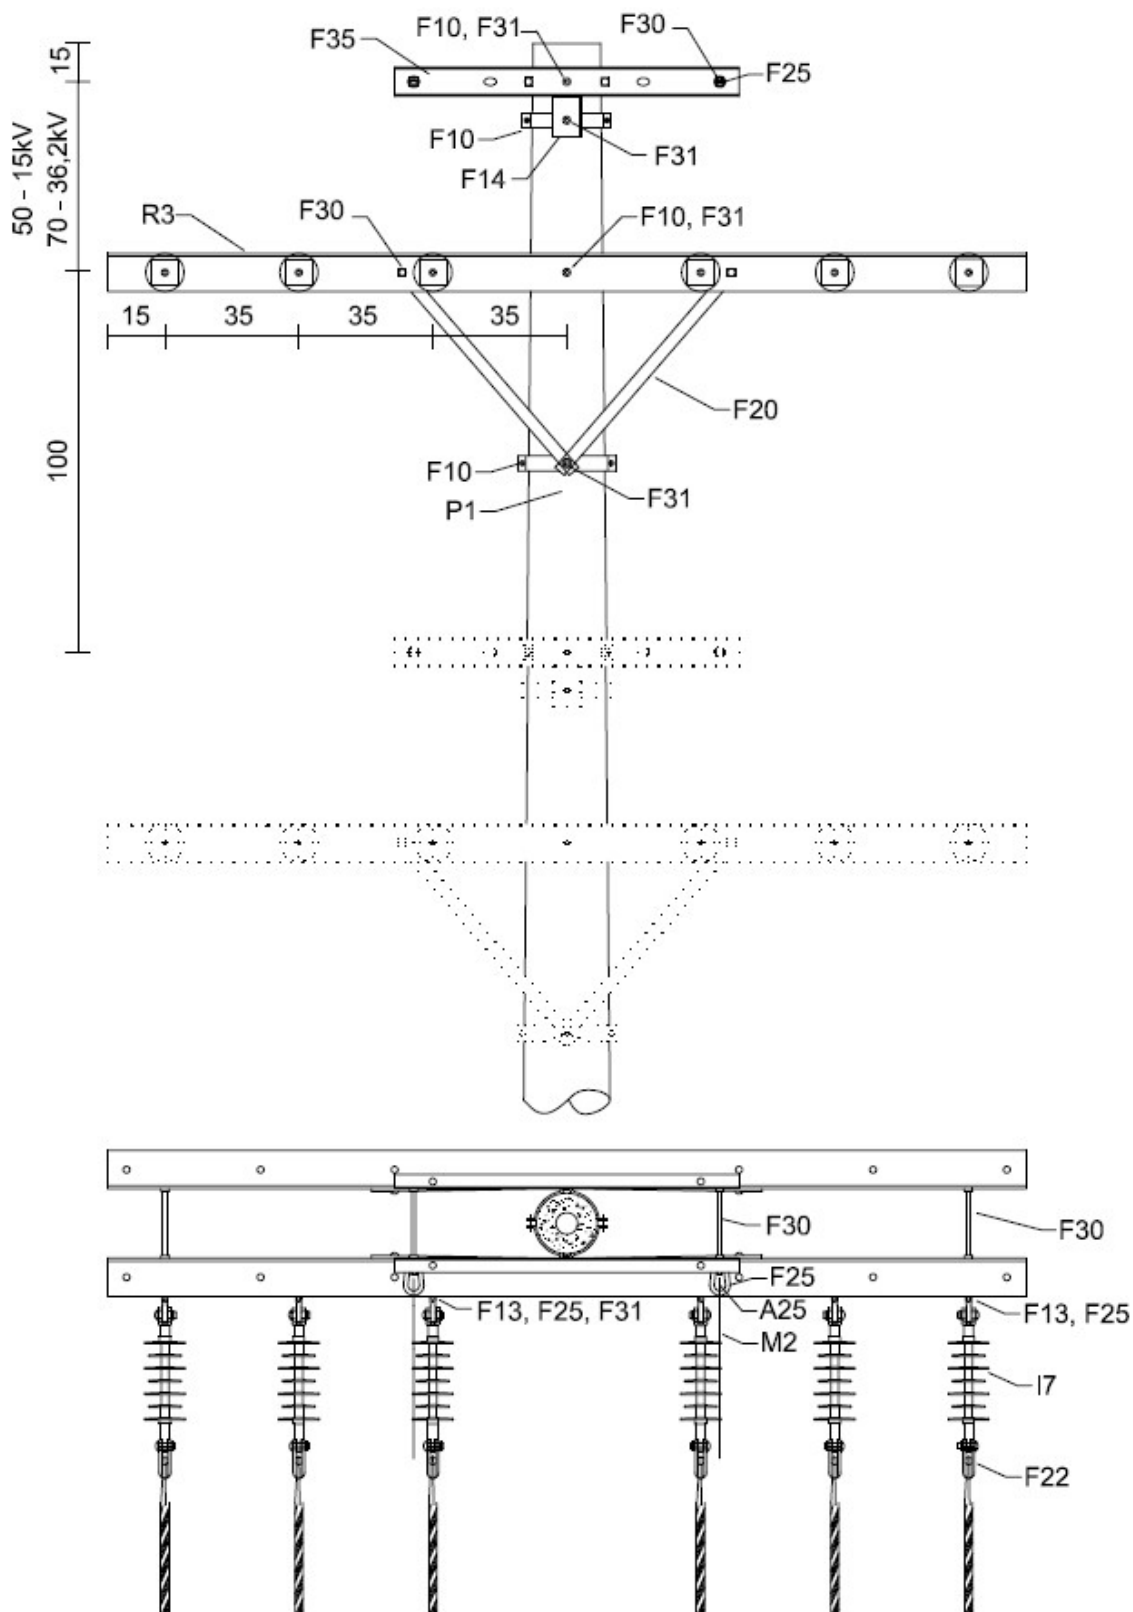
Estrutura CE33 – Poste de Concreto de Seção Circular
